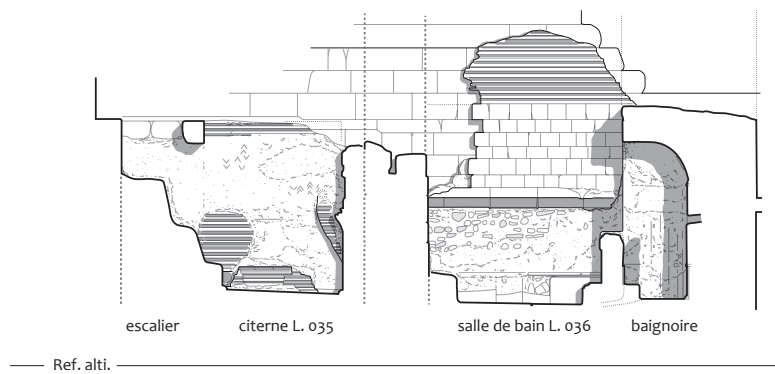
Le «Palais de Trajan», coupe 8, coupe-élévation est-ouest, vers le sud, sur les salles 35 et 36 des bains (1/100^e)
